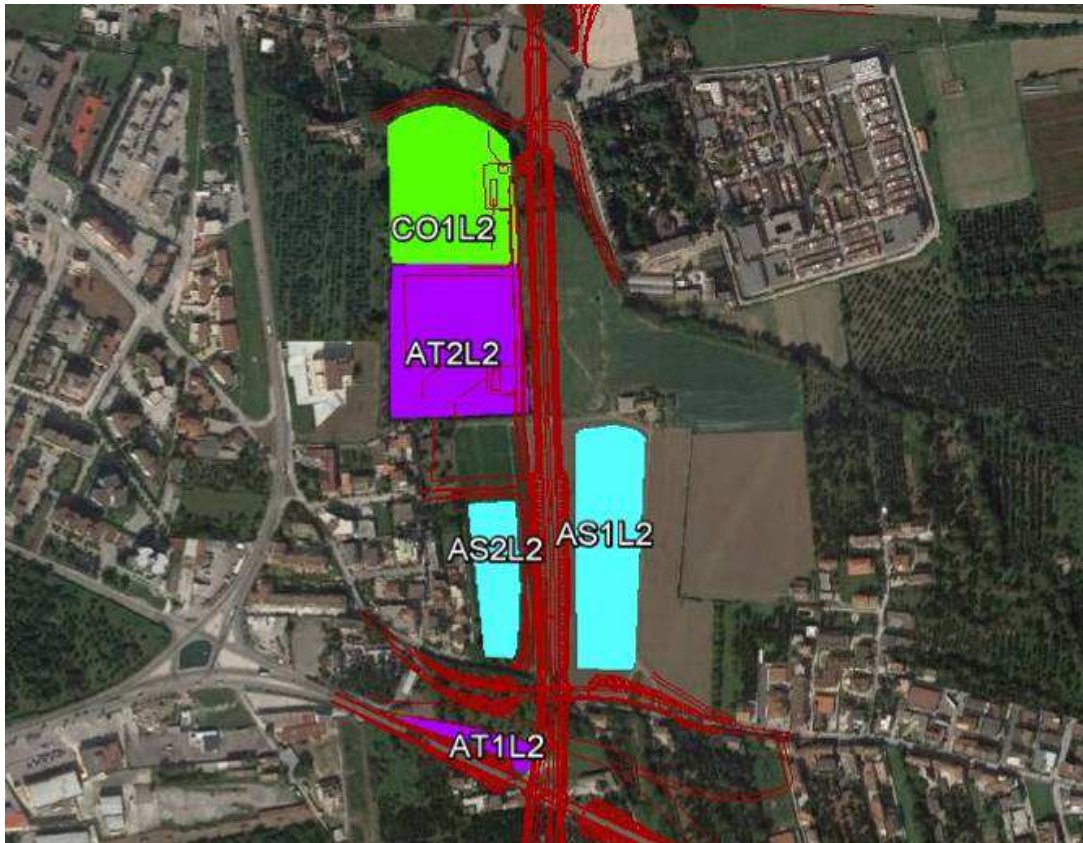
Ubicazione cantiere AS.1-2.L2
